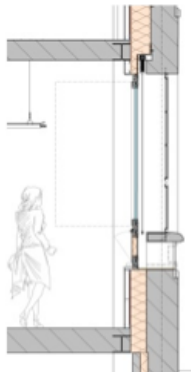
Coupe dans la façade avant (A2M, 2010)
